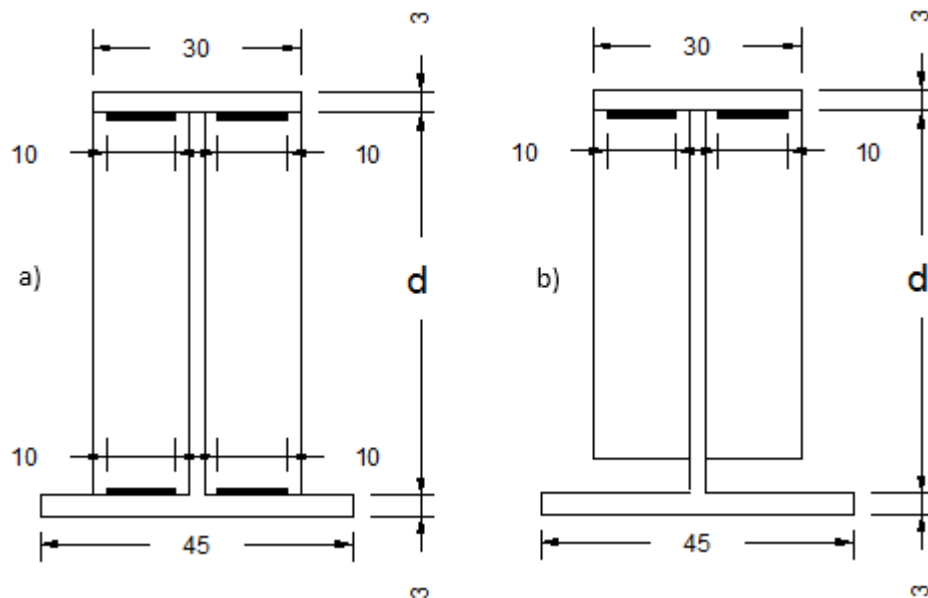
Ubicación del cordón de soldadura patín superior e inferior con el rigidizador transversal de apoyo (a). Ubicación del cordón de soldadura patín superior con el rigidizador transversal intermedio (b) (vista frontal)
